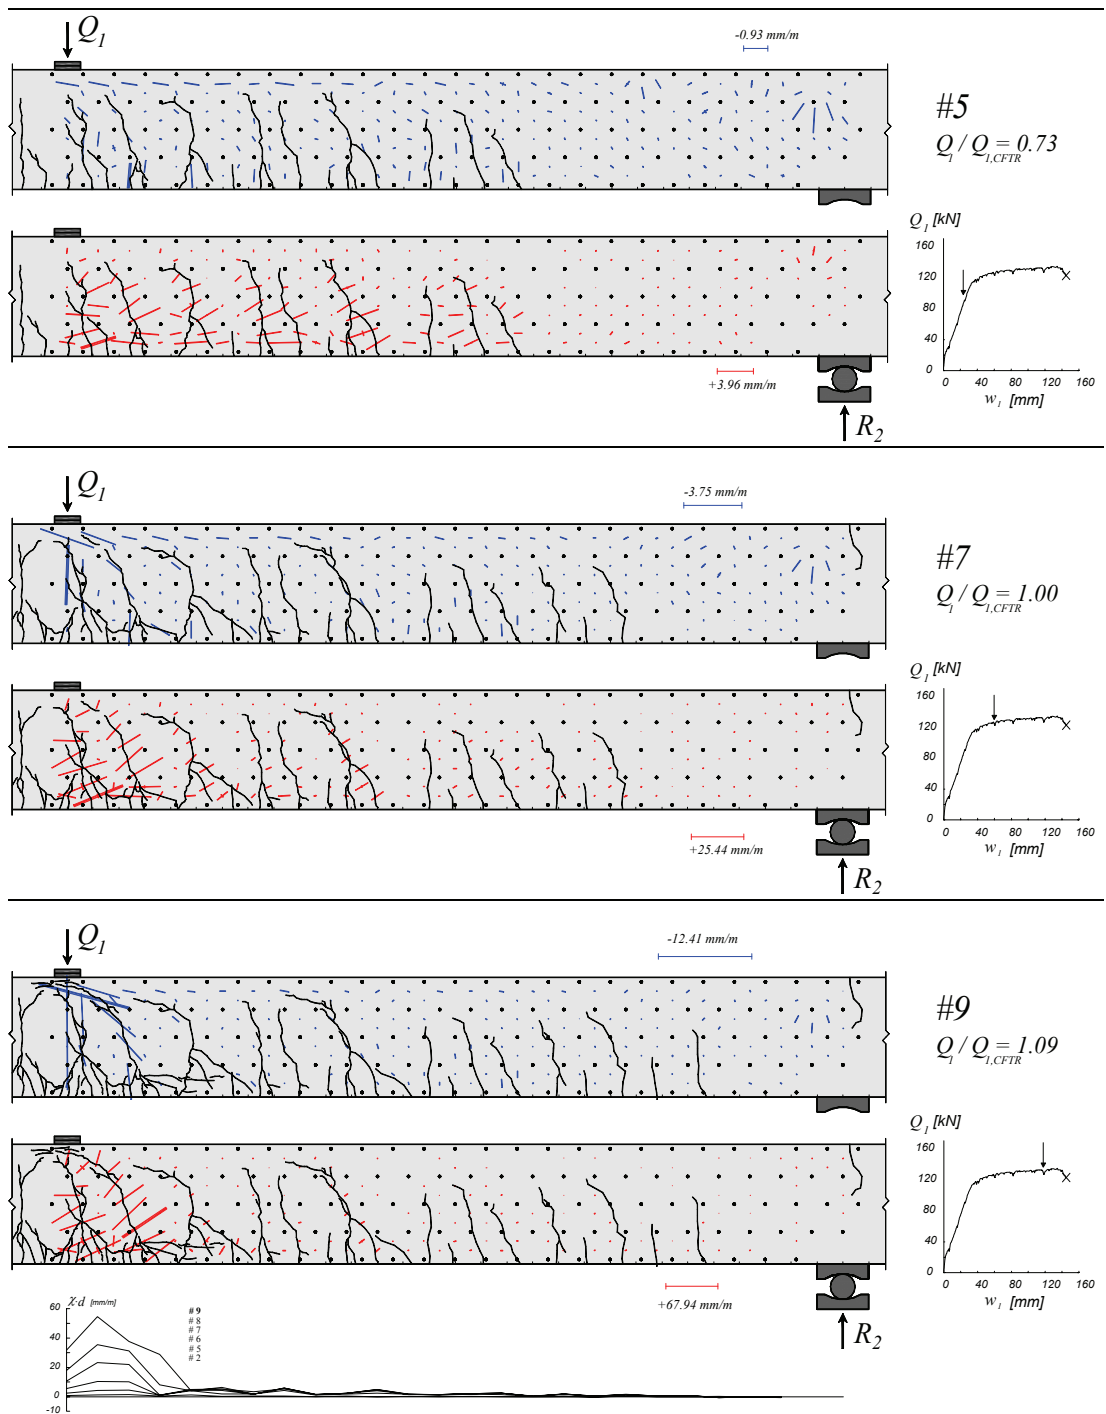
Poutre SR7: déformations principales, fissuration et courbures
